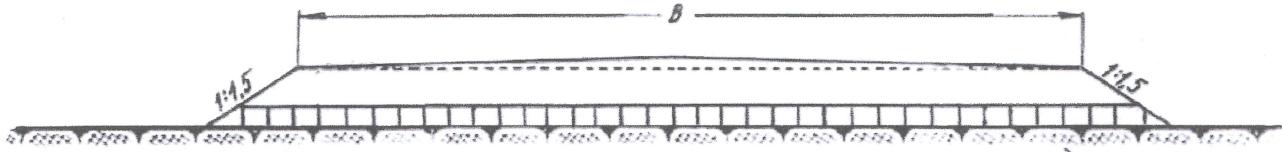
Поперечный профиль насыпи, возводимой из местных грунтов с основанием, армированным геоячееками «ПРУДОН-494»
